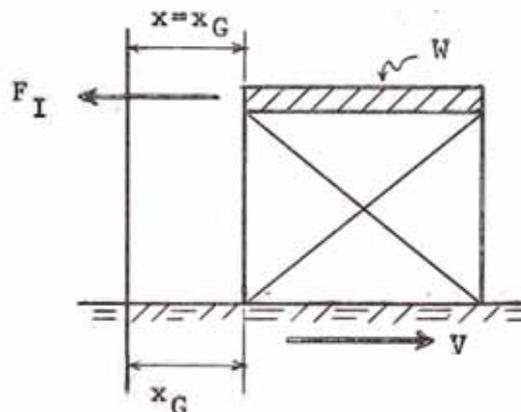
Fuerza Sísmico : Estructura Rígida
